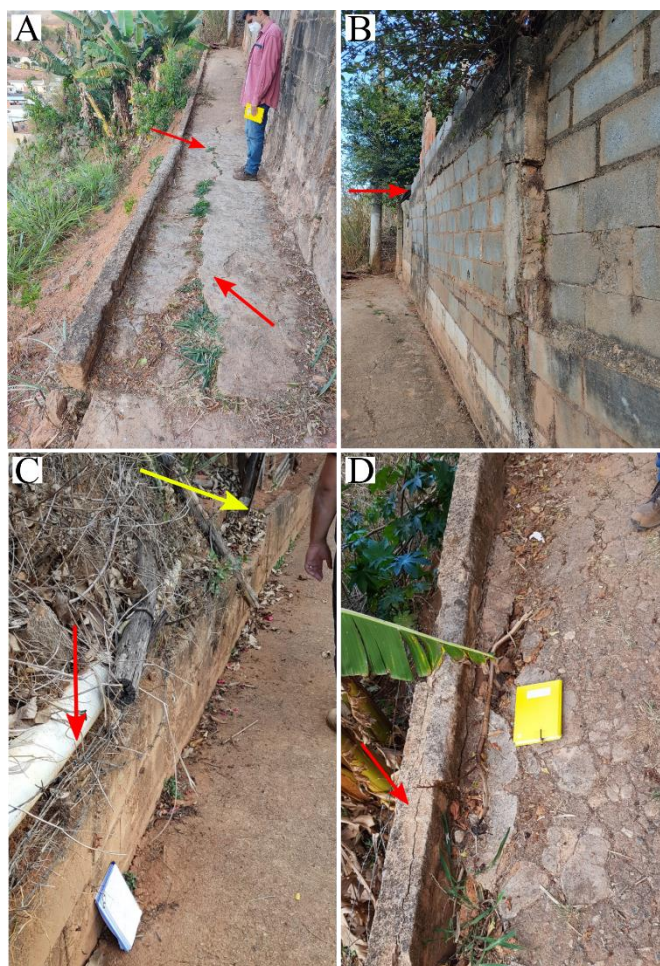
Via a jusante do muro de bloco cimentício. A) Trincas e abatimento no calçamento (setas vermelhas); B) Muro de concreto com inclinação em direção à via (seta vermelha); C) Embarrigamento (seta vermelha) e desalinhamento do muro (seta amarela); D) Meio fio com trincas (seta vermelha).
